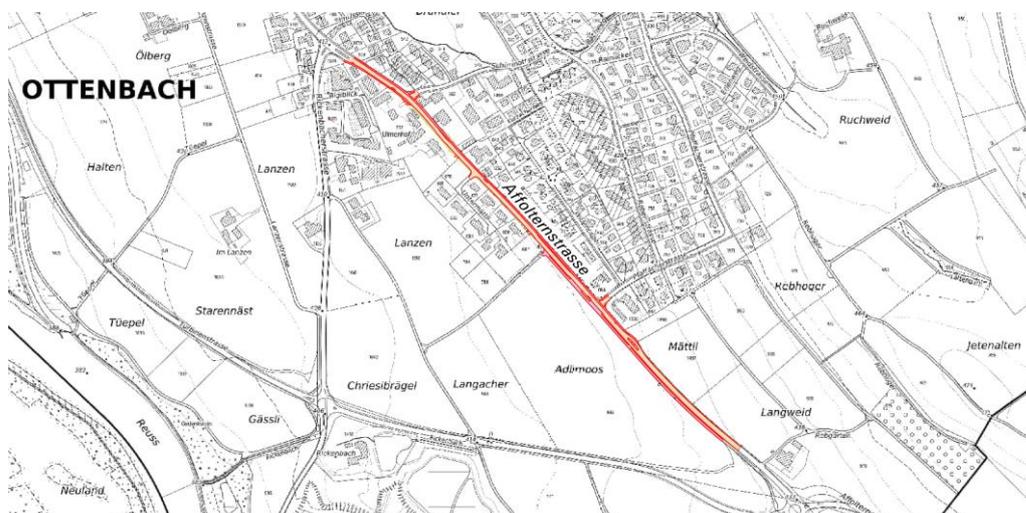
Projektperimeter Sanierung Affolternstrasse
